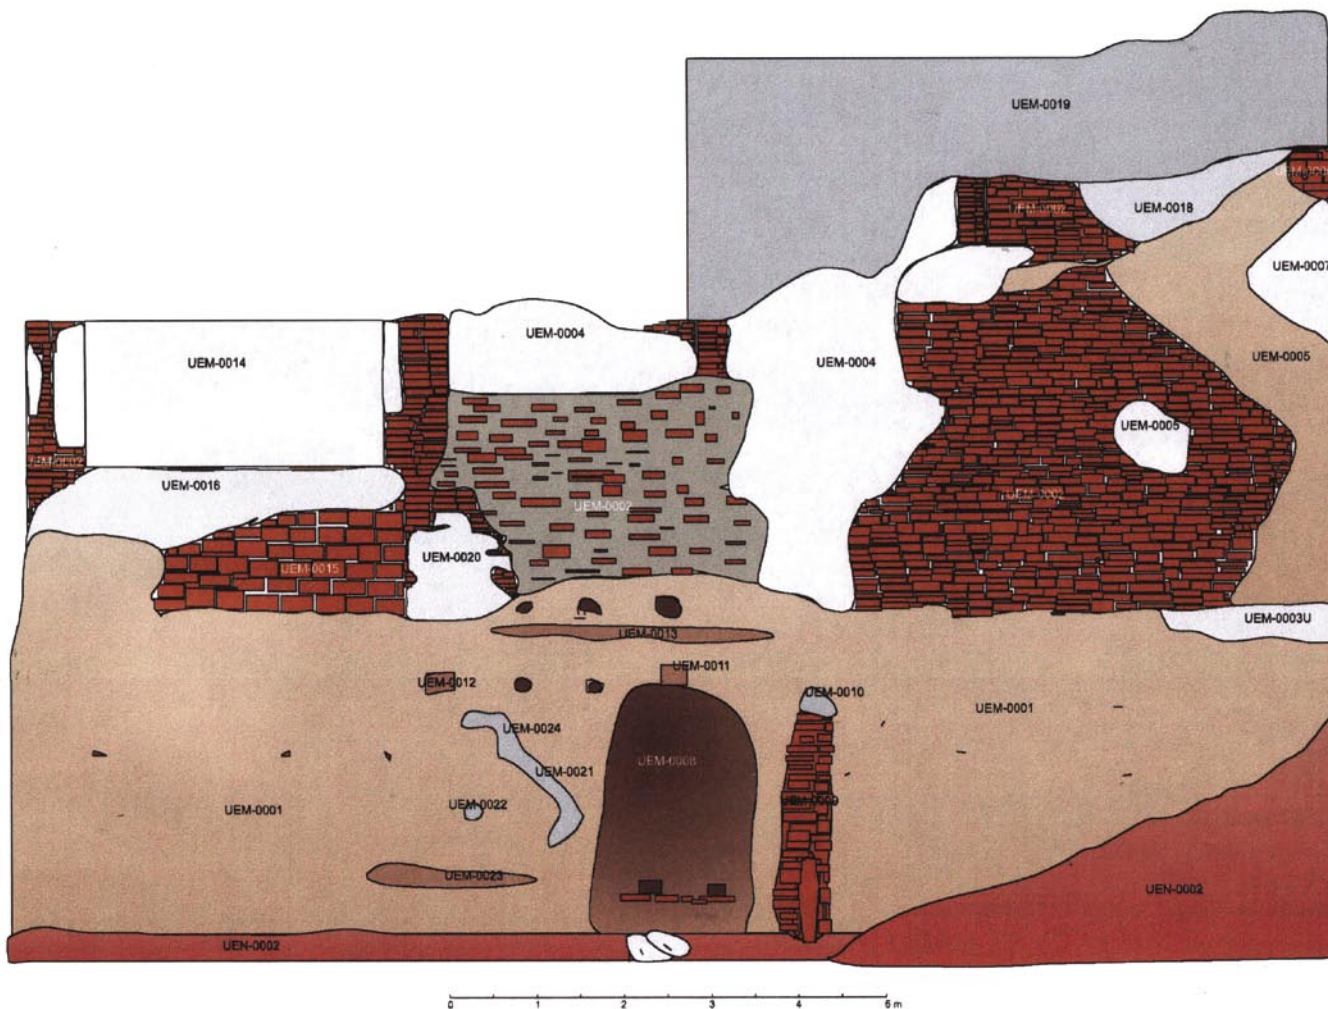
Alzado de la muralla y demás estructuras murarias E. 1:20
